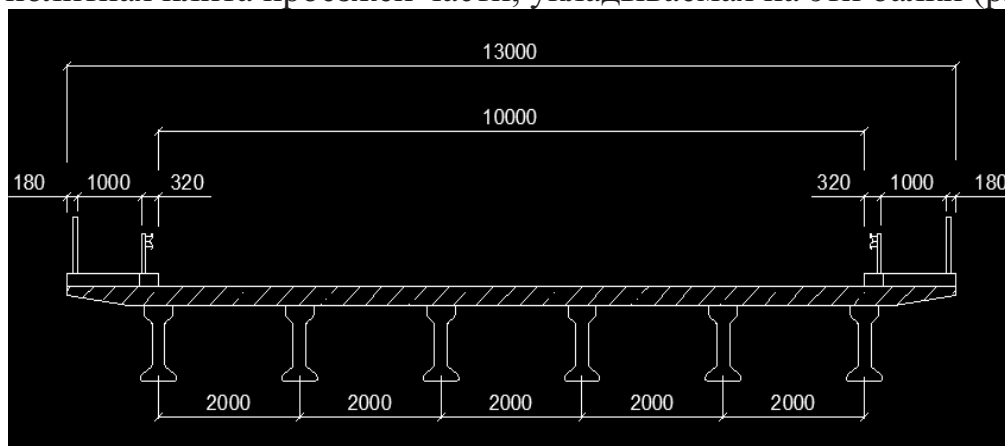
Поперечный разрез моста со сборно-монолитным типом конструкций
